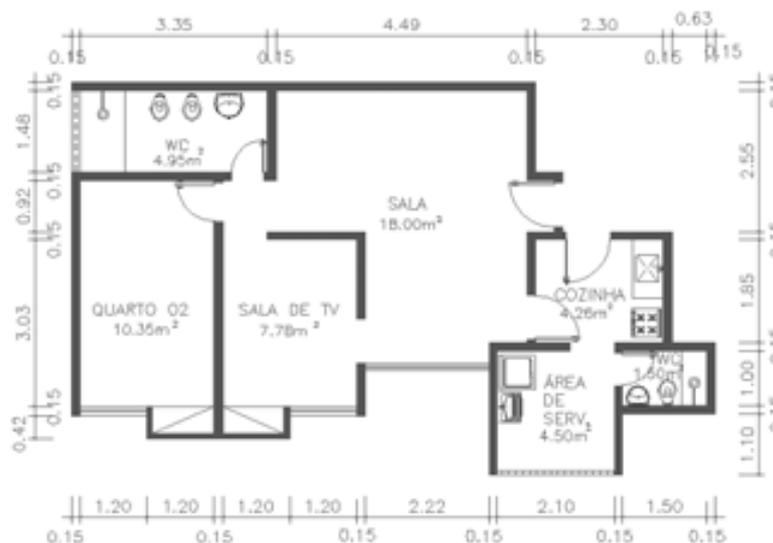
Asa Norte - SQN 314 – Planta Original
